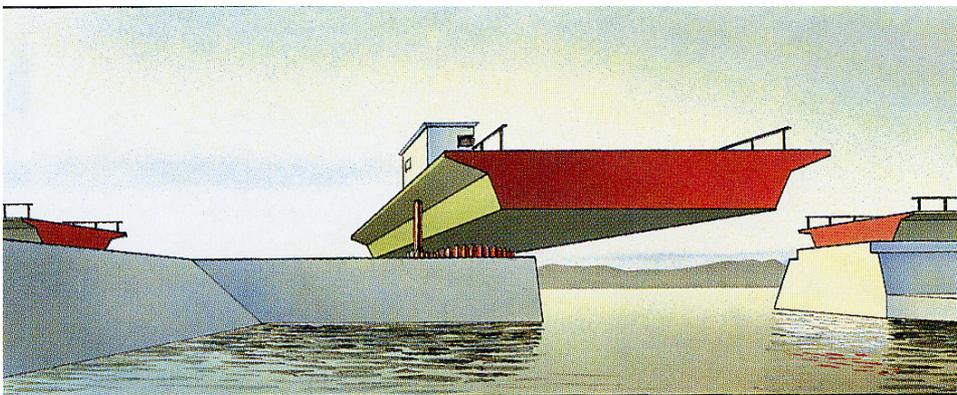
Drehbrücke wird beim Durchlass der Schiffe geöffnet
